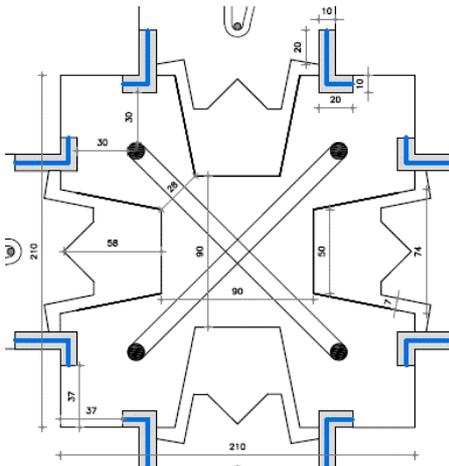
Detalhes do pilar entre três ou mais painéis de parede (medidas em mm).
